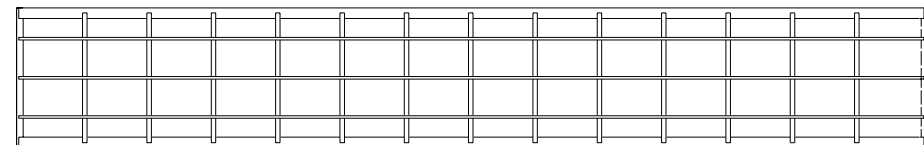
Lamelle Typ 2 - untere Leistenlage
